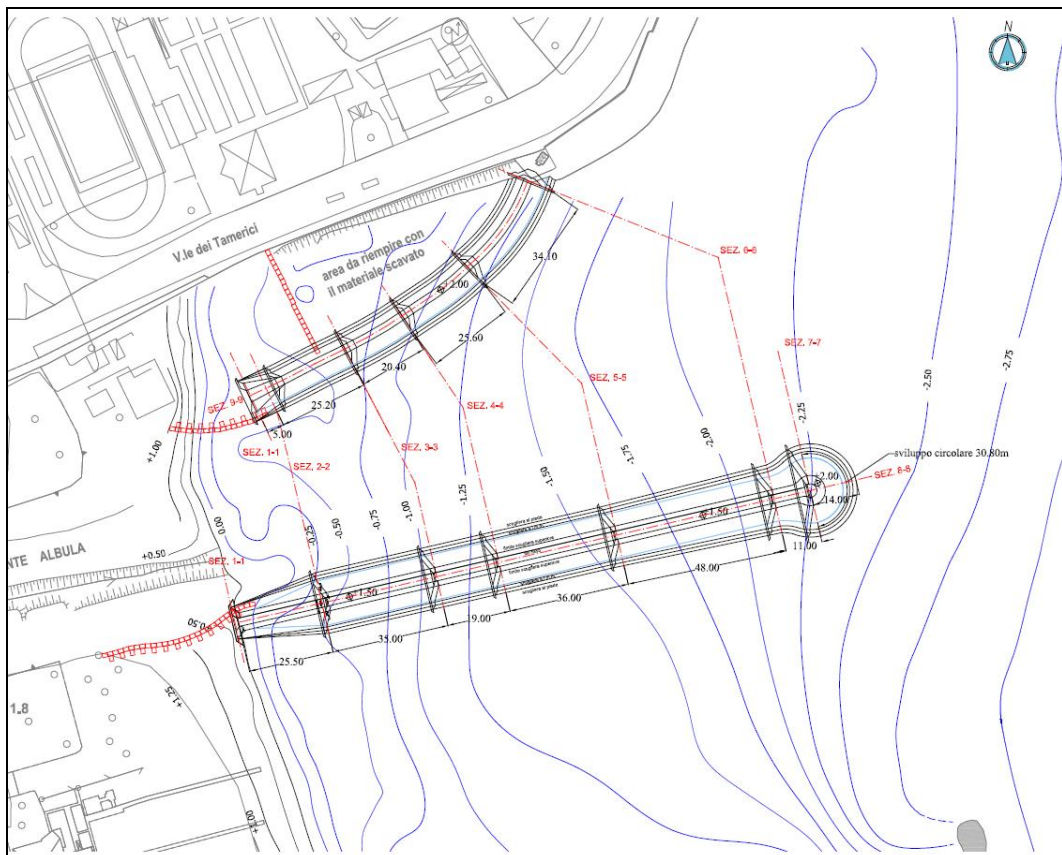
Planimetria delle opere da realizzare nel progetto.
